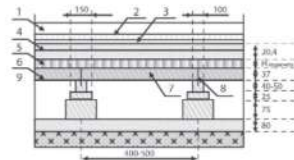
Укладка напольного покрытия на старом дощатом полу: использование ГВЛ или фанеры
